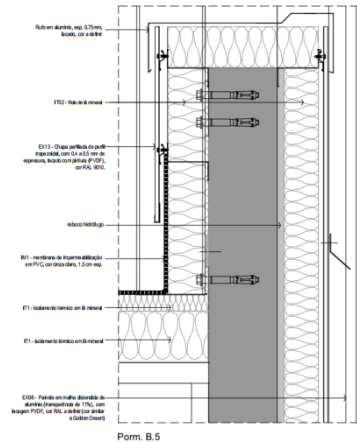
Pormenor de impermeabilização da Fachada ( $h > 0.50$  m) - Coroamento da Platibanda
